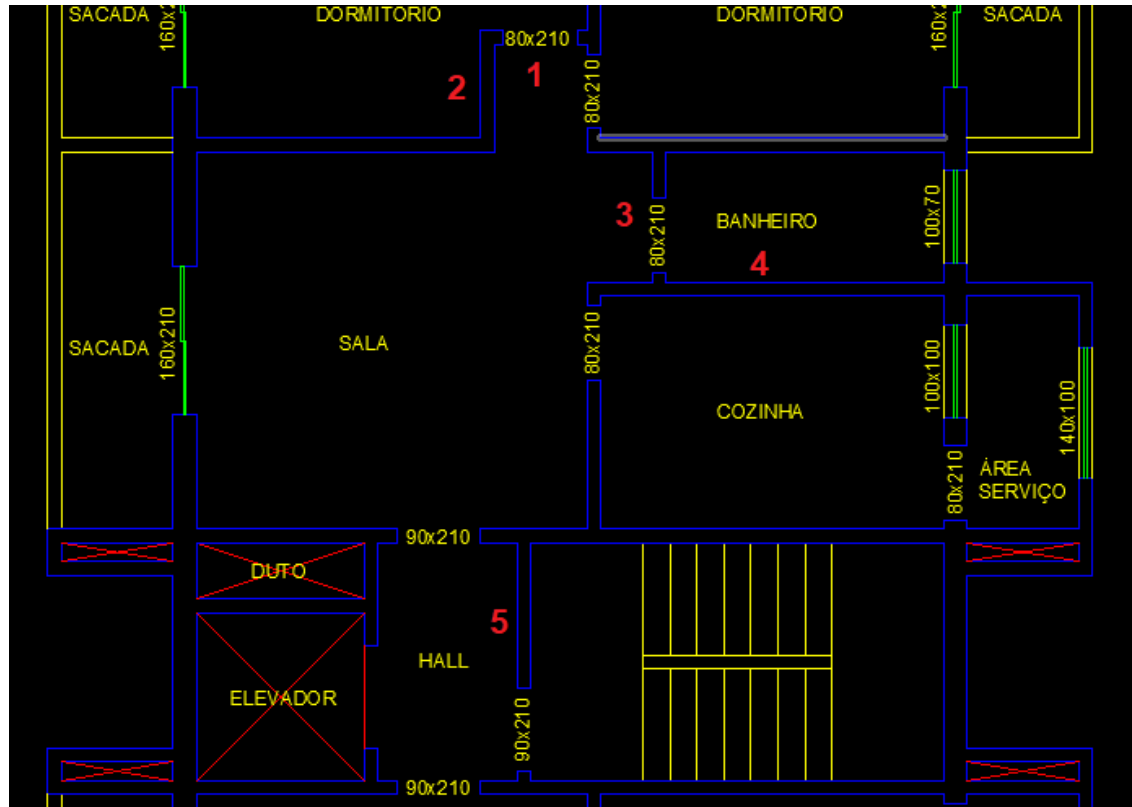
Paredes sobre lajes representadas na planta baixa do pavimento tipo
